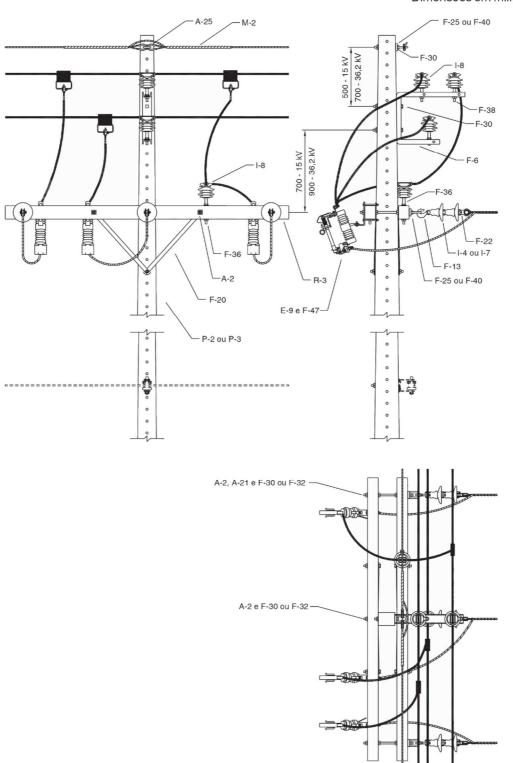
Estrutura CE2-N3 CF - Poste de concreto de seção DT ou de madeira
